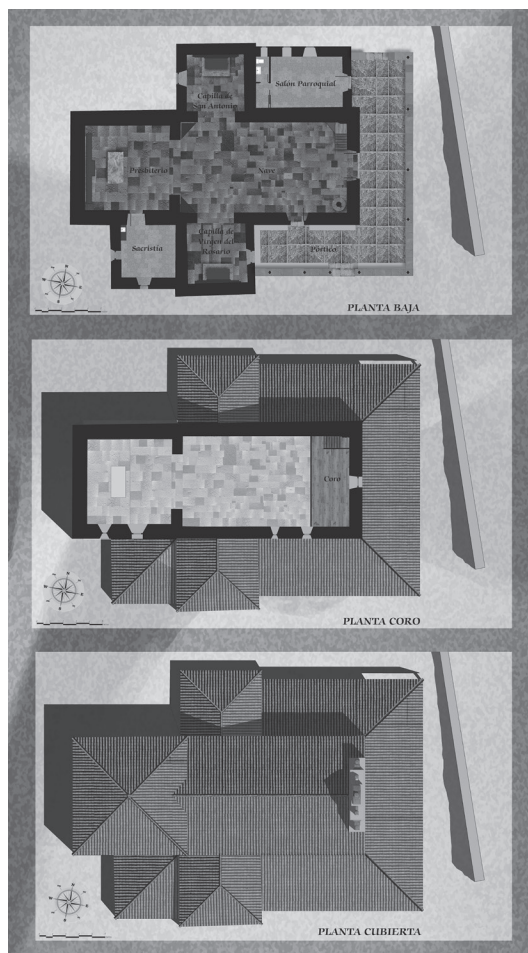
Plantas de estado reformado de la Iglesia: Planta Baja, Planta Coro y Planta Cubiertas.
